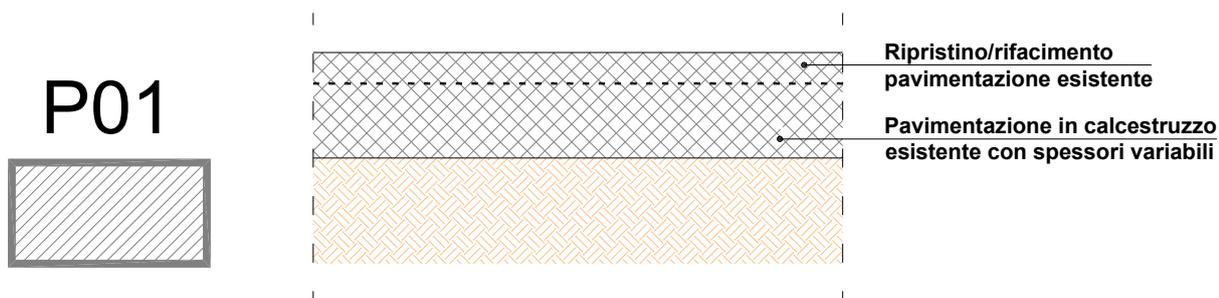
Interventi di pavimentazione tipo P01 - Ripristino pavimentazioni esistenti.
